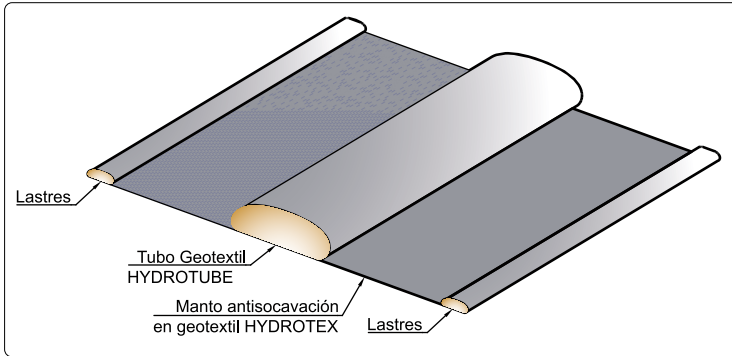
Sección transversal típica de un tubo geotextil Hydrotube
